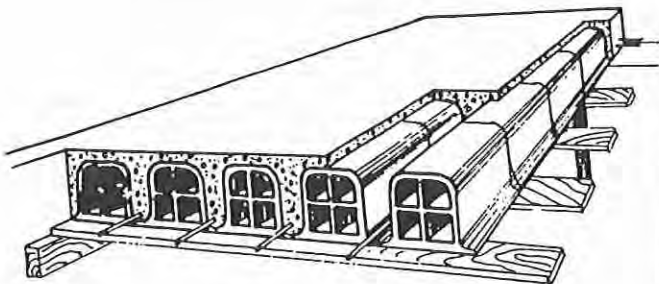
Schéma de montage d'un plancher sur coffrage.
